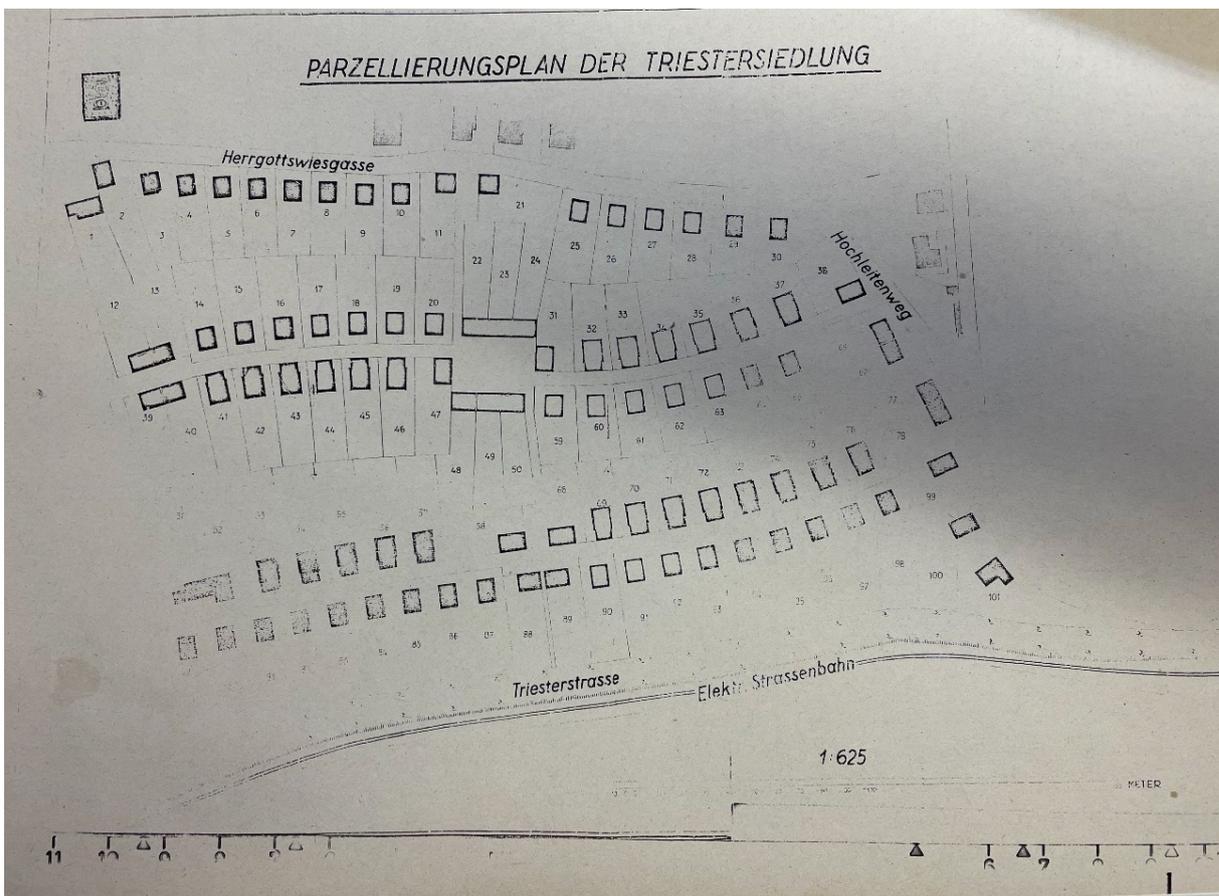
Parzellierungsplan der Triestersiedlung 1926 mit der schon damals vorgegebenen Grundstücksaufteilung und auch der Positionierung der Hauptgebäude. (Quelle: Stadtarchiv Graz)
